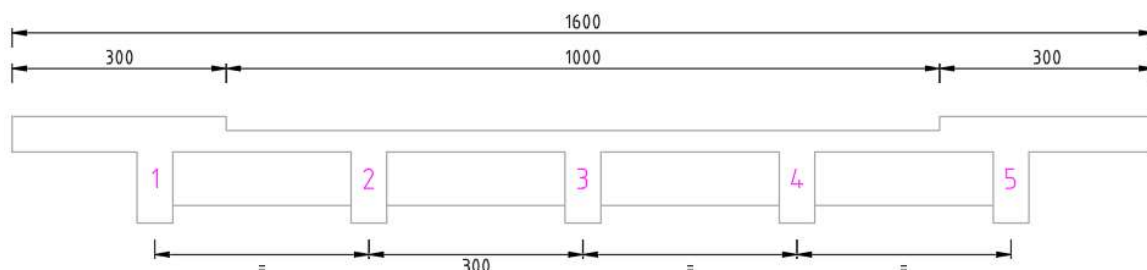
Sezione trasversale di calcolo dell'impalcato (trave tampone)
